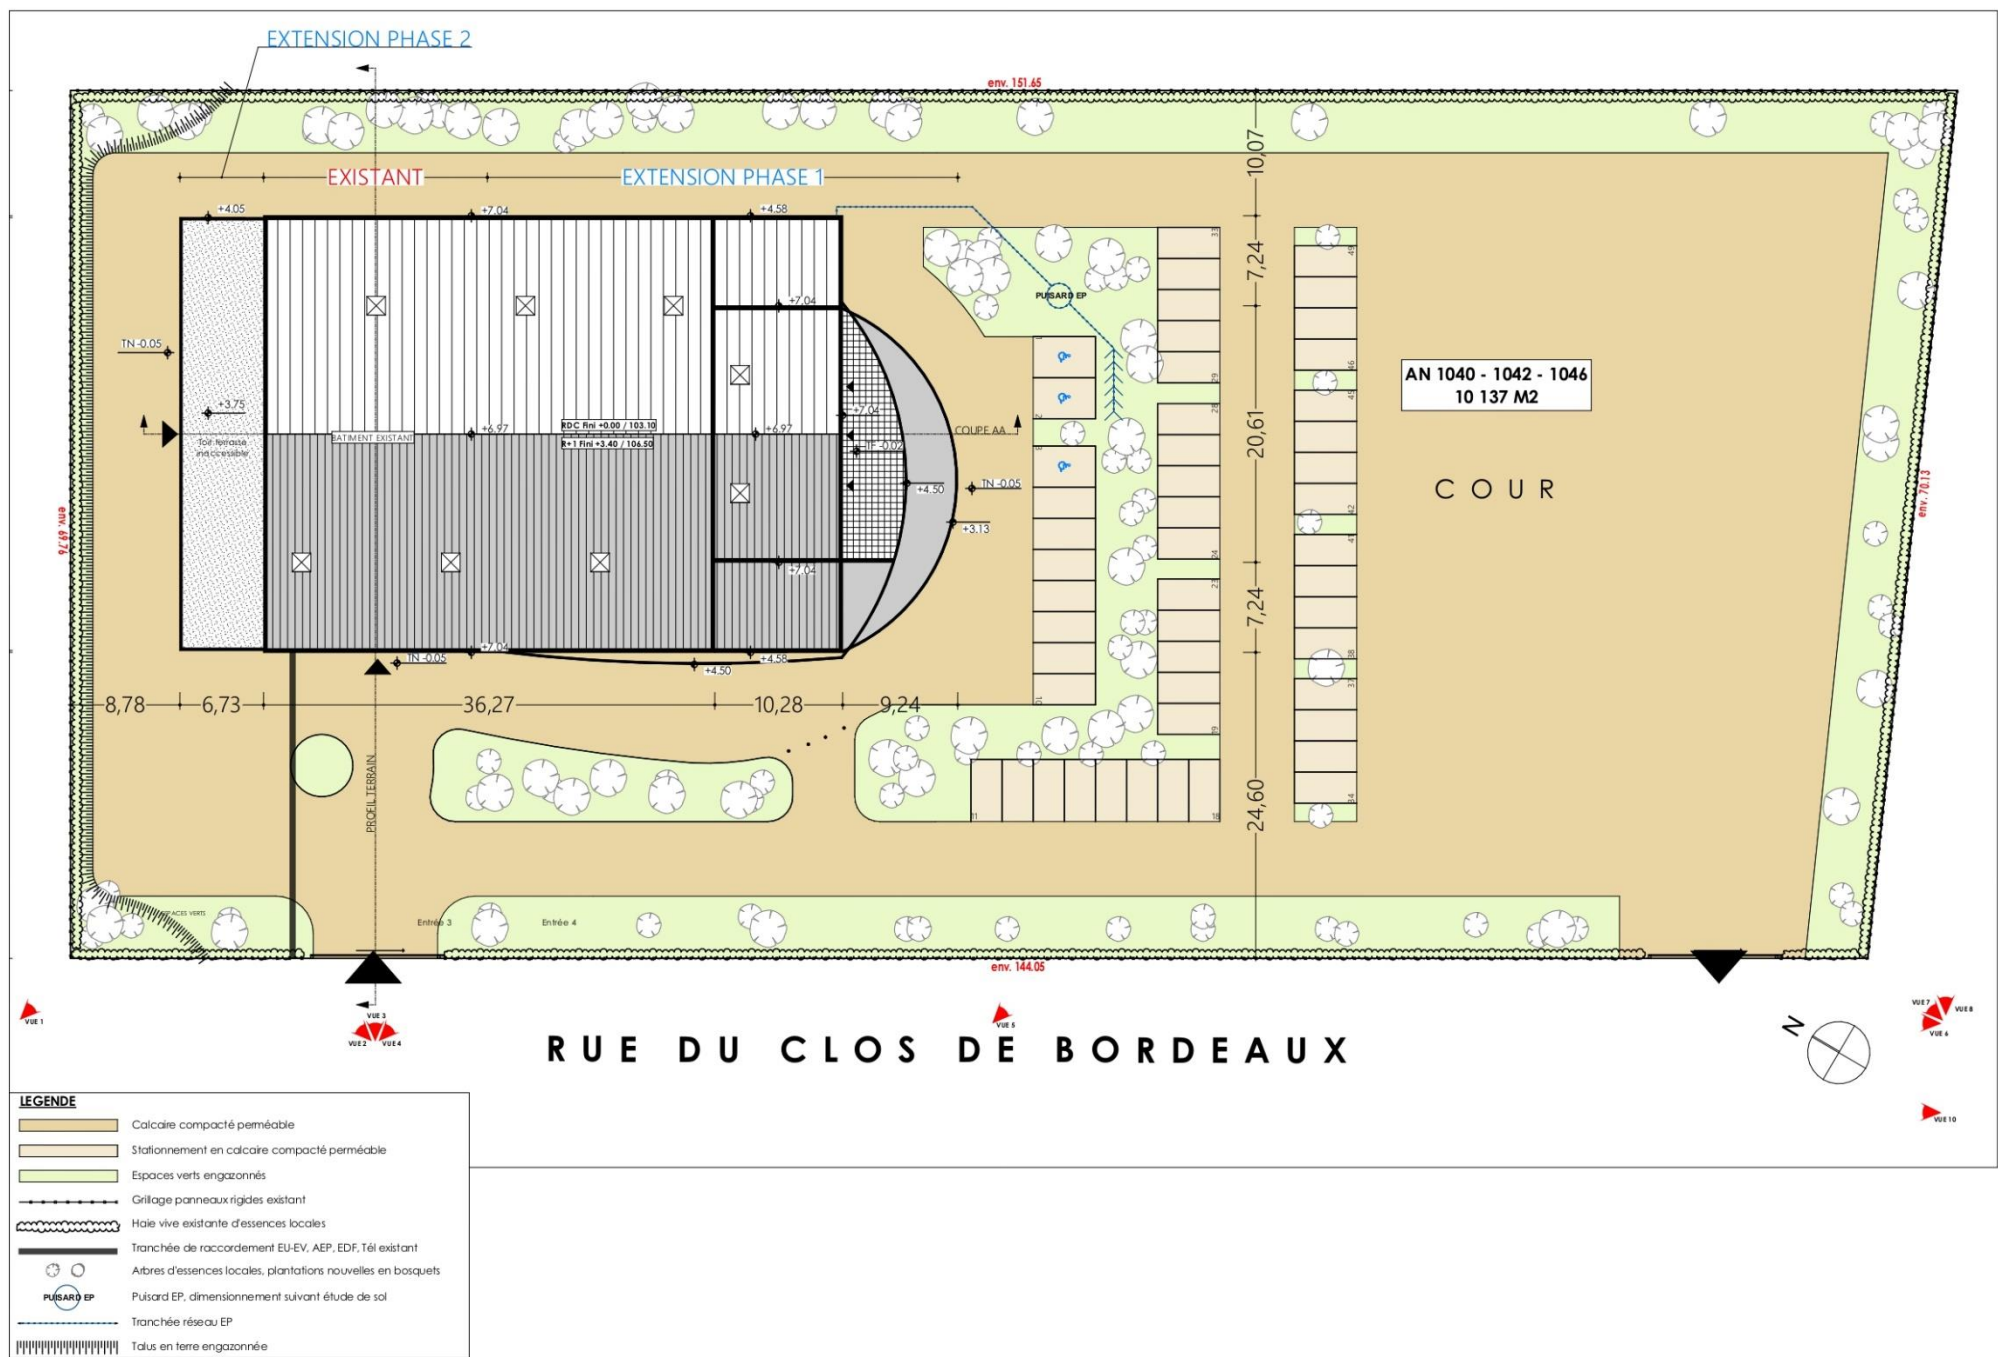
Plan de masse du projet (Source : SCI BTO)
